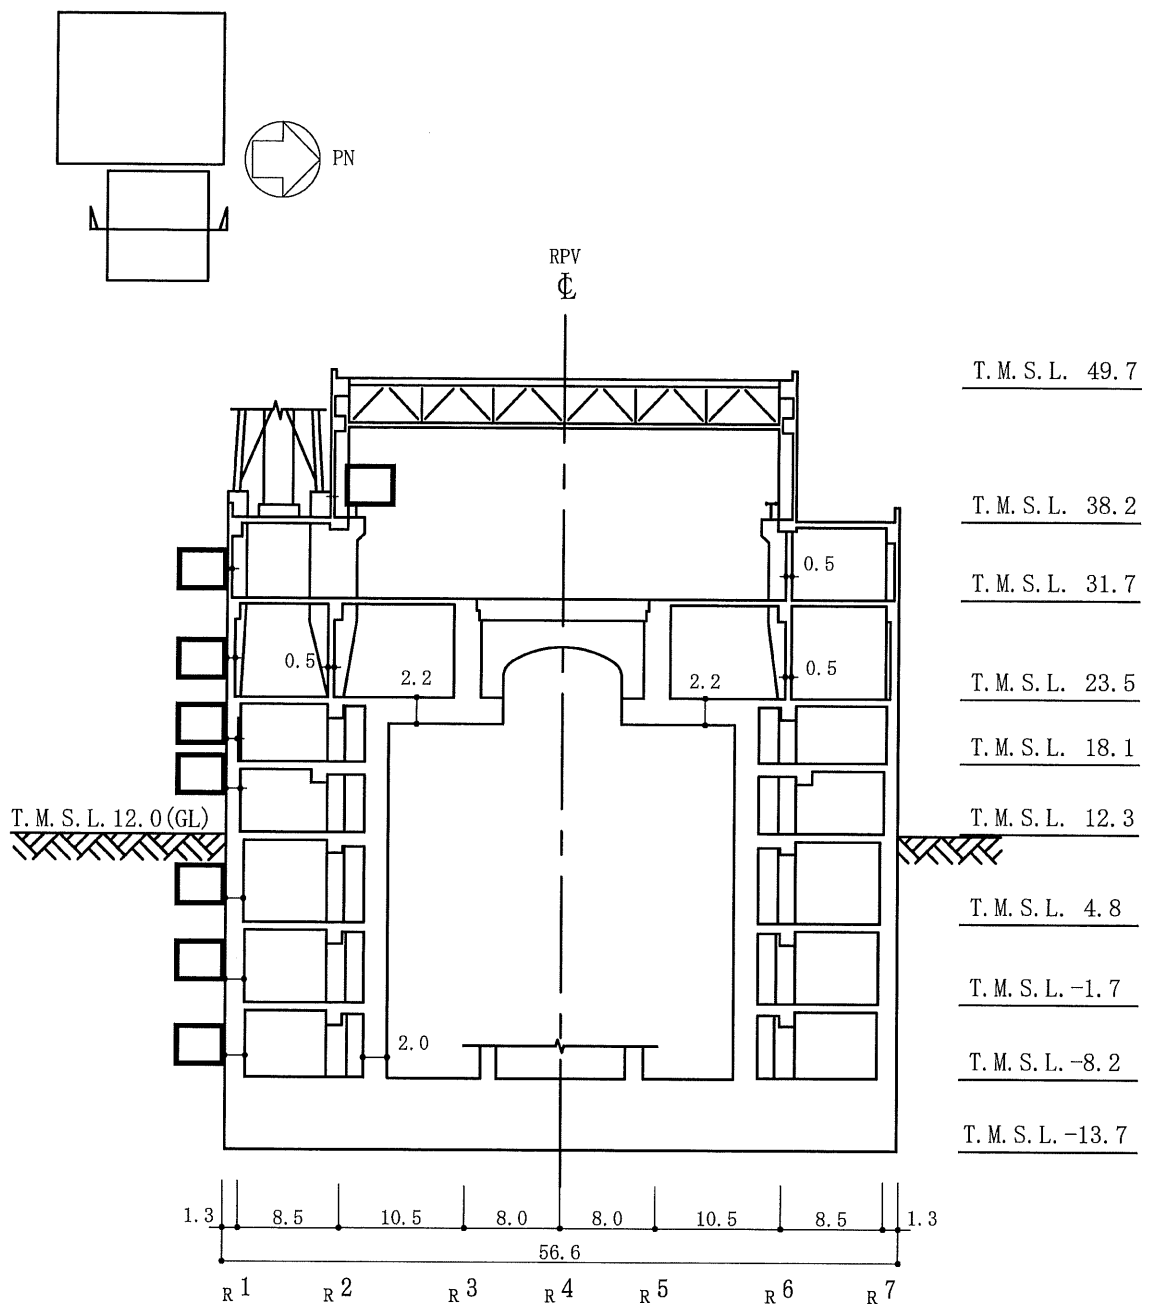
原子炉建屋の概略断面図 (NS方向) (1/2) (単位 : m)
